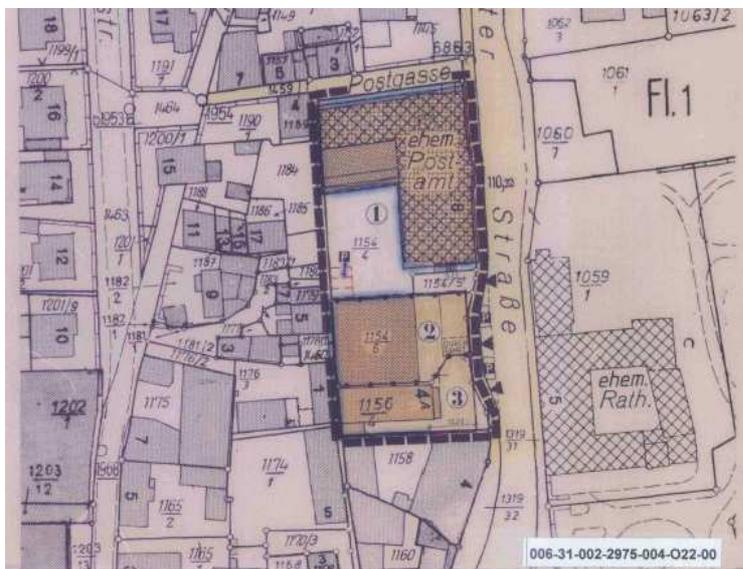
Bebauungsplan BO 22 (o.M.)
